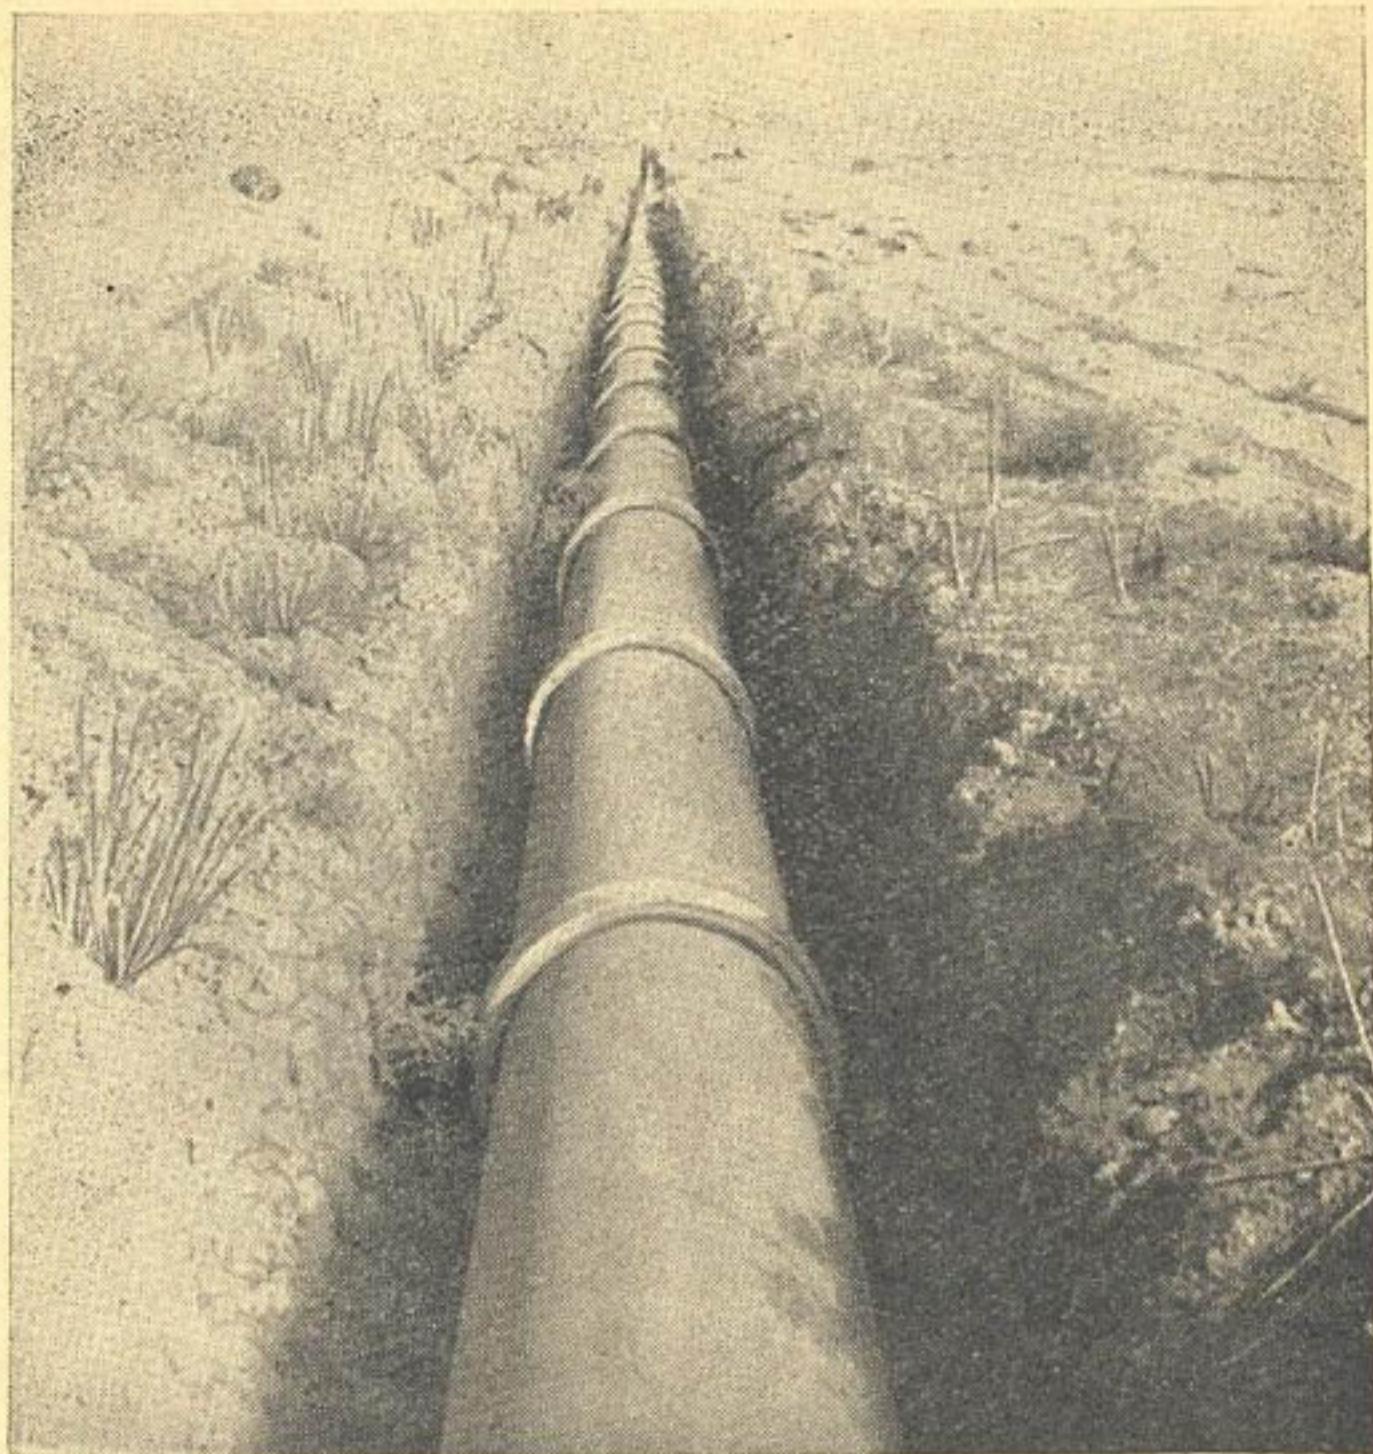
Асбестоцементный трубопровод закрытой оросительной сети, уложенный в траншеею (Голодная степь).
